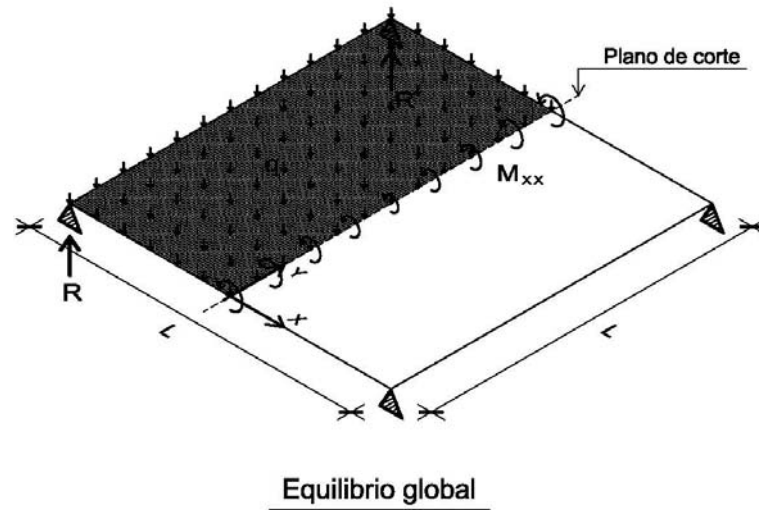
Losa cuadrada simplemente apoyada en sus esquinas con plano de corte en eje de simetría.
